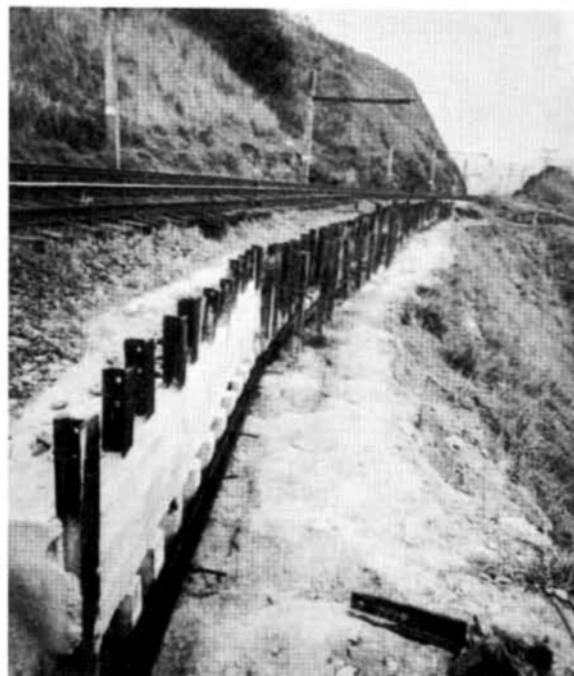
Estabilização de taludes com trilhos ancorados – RFFSA, Linha do Centro da EFCB – Paulo de Frontin
